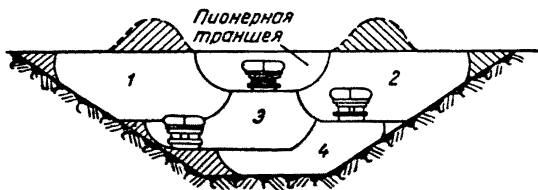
Схема разработки пионерной траншеи с отвалом грунта на верх последующих проходок
